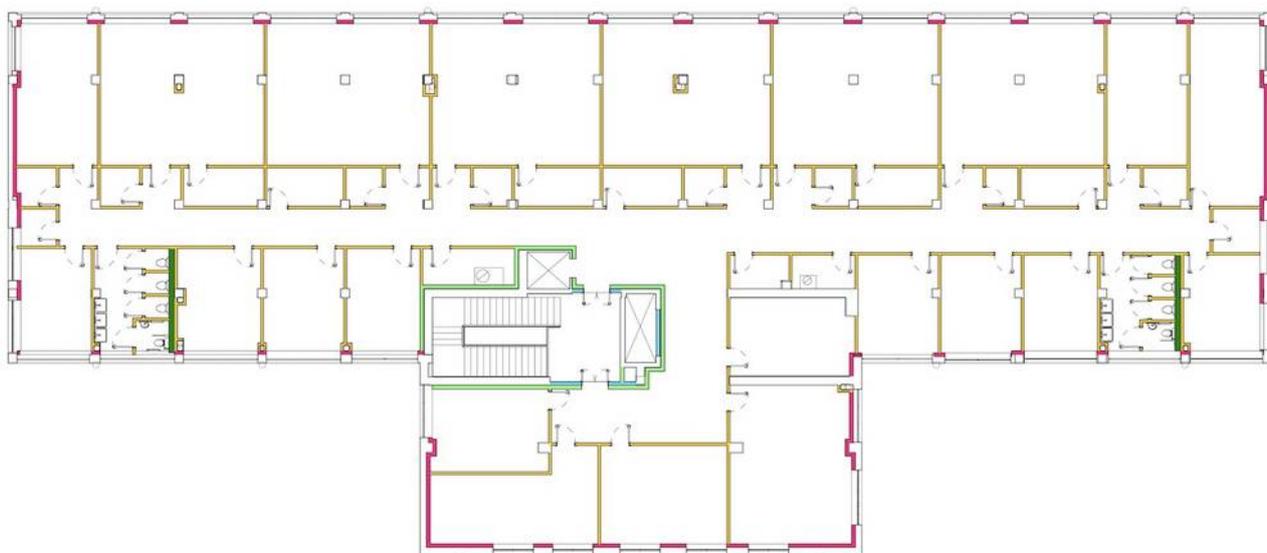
Pianta sinottica delle nuove pareti del piano secondo
